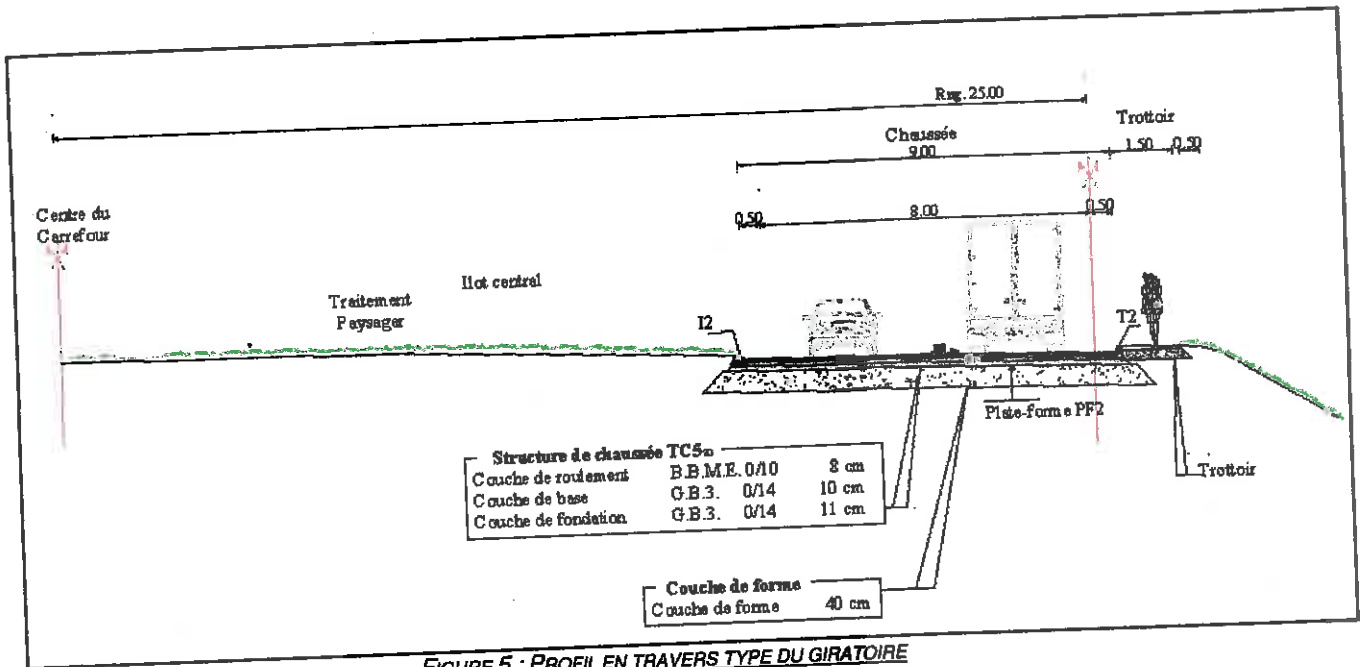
PROFIL EN TRAVERS TYPE DU GIRATOIRE
